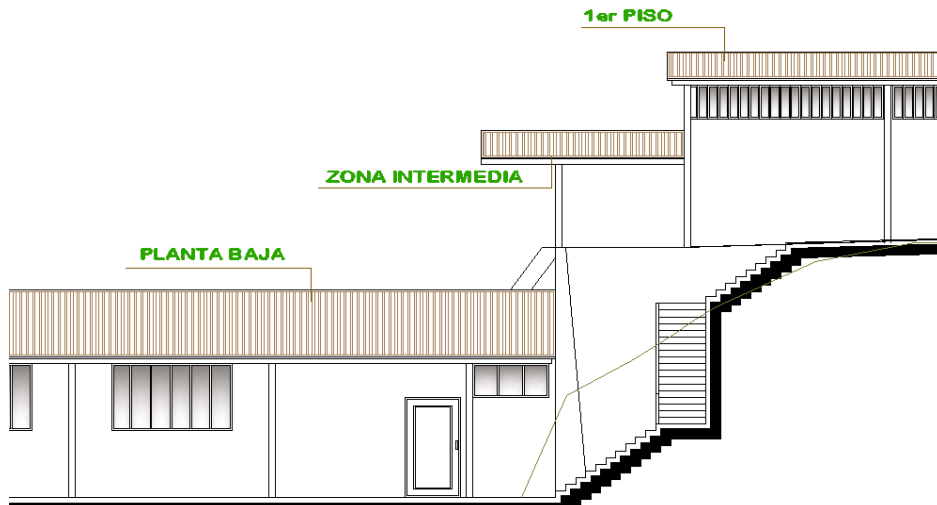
Fachadas y niveles (planta de reciclaje)
